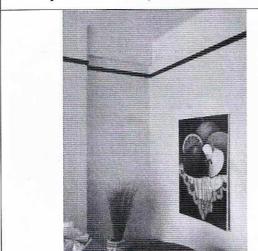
y 22. Vista interior apartamento 501. Humedades y eflorescencias en cielorrasos. Muros, vigas y columnas sin daño
